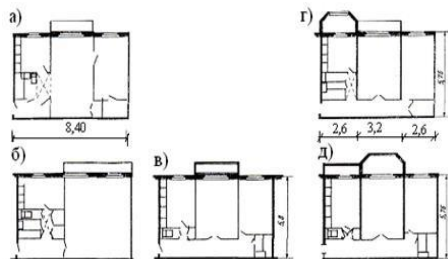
Модернизация планировки двухкомнатной квартиры, а-исходная планировка, б,в-варианты перепланировки с продольными несущими стенами, г,д-с поперечными.
